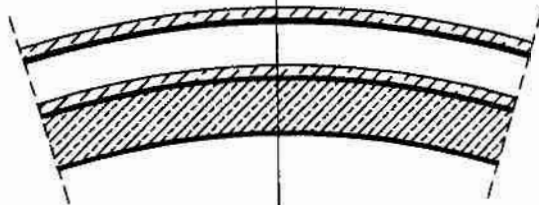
Przypadki zabezpieczenia konstrukcji nośnej tunelu
